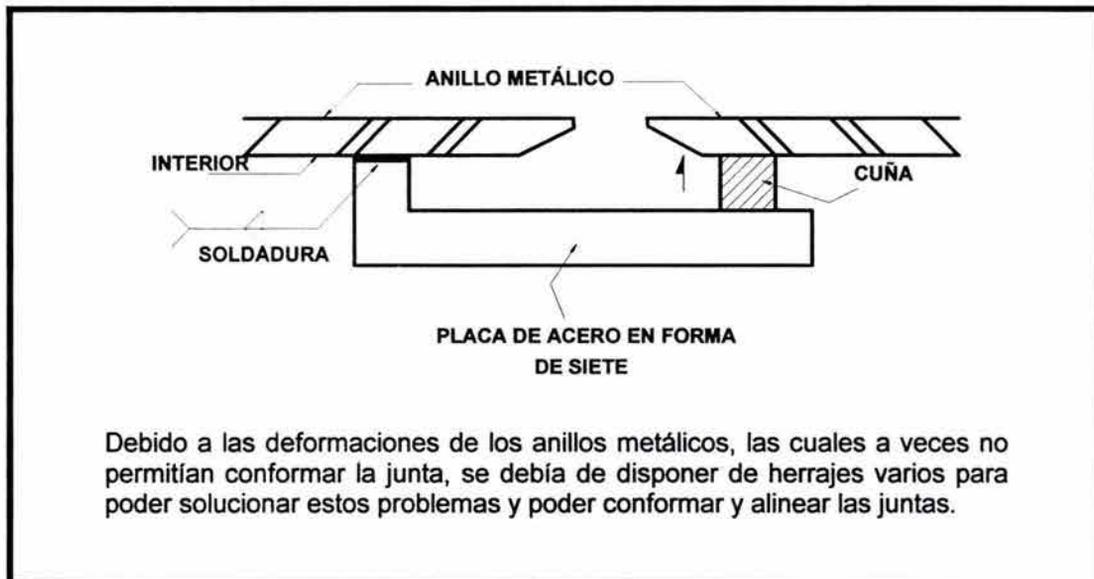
COLOCACIÓN DE PLACAS EN ANILLOS METÁLICOS
